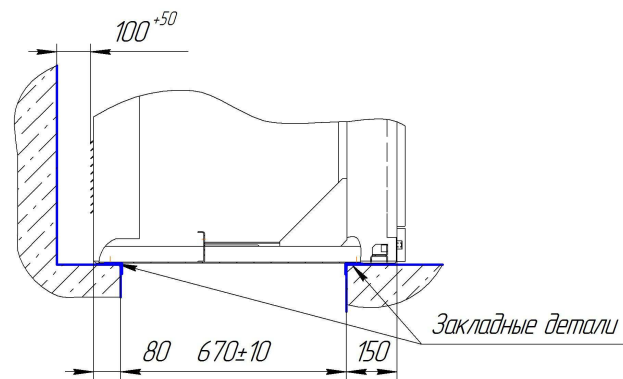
Установка КРУС-СЭЩ-75 на закладные детали:
